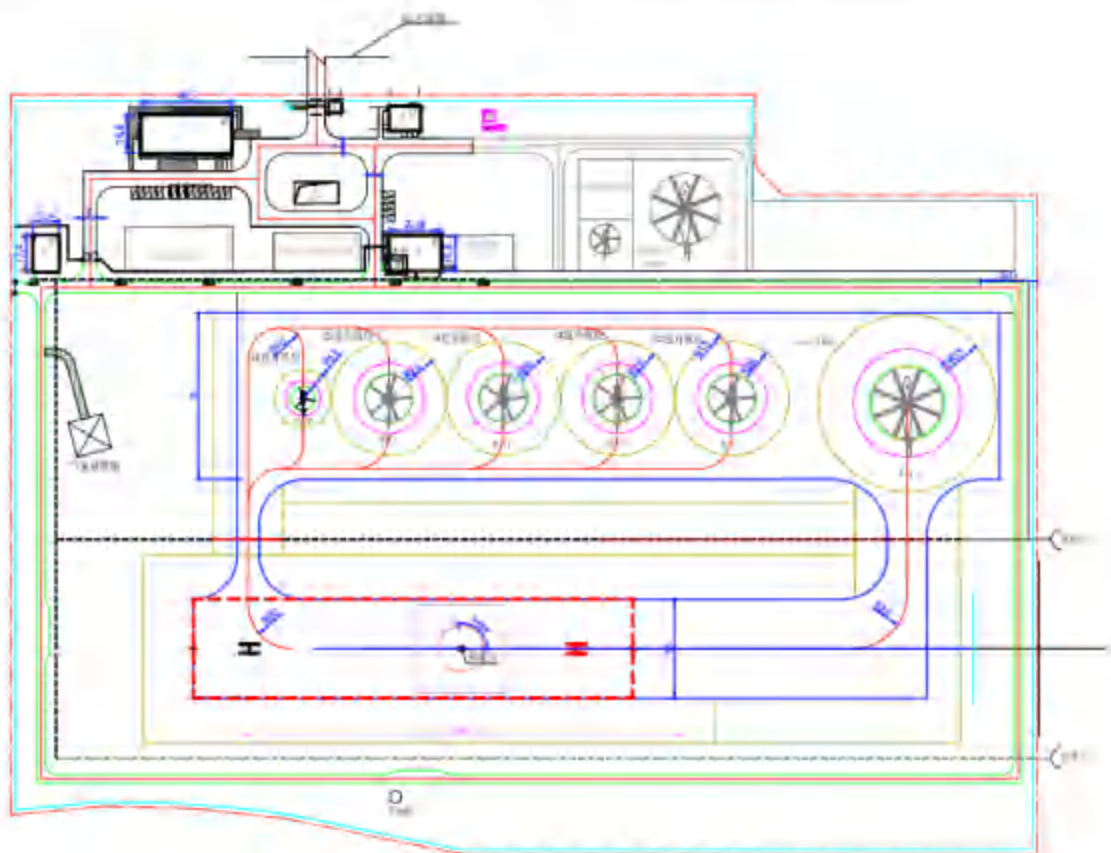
枝江通用机场（直升机场）近期平面布置图
